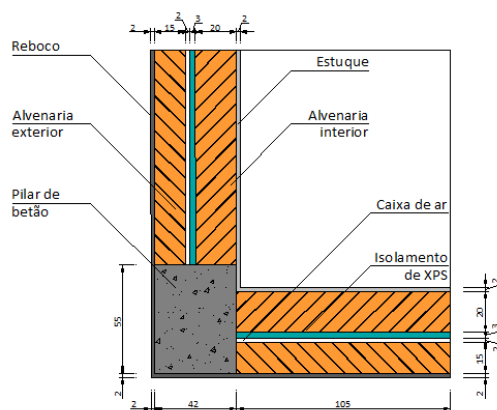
Ponte térmica linear da ligação entre duas fachadas e da ligação entre o pavimento e a fachada, observada pelo interior do Edifício VII.
